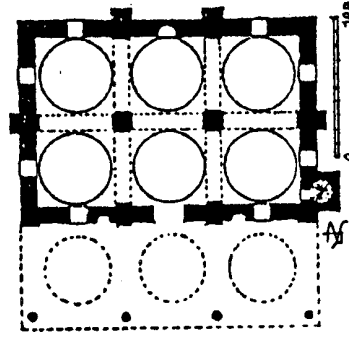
مسقط أفقي للجامع الكبير في بورصة
